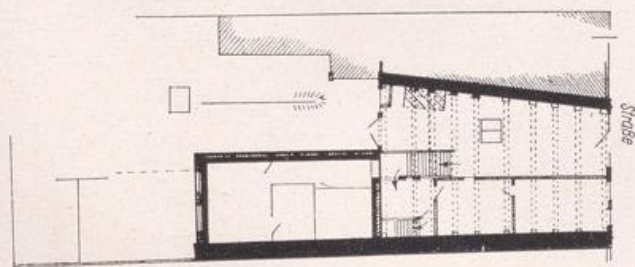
Osnabrück, Grundriß des Hauses Lohstr. 61
